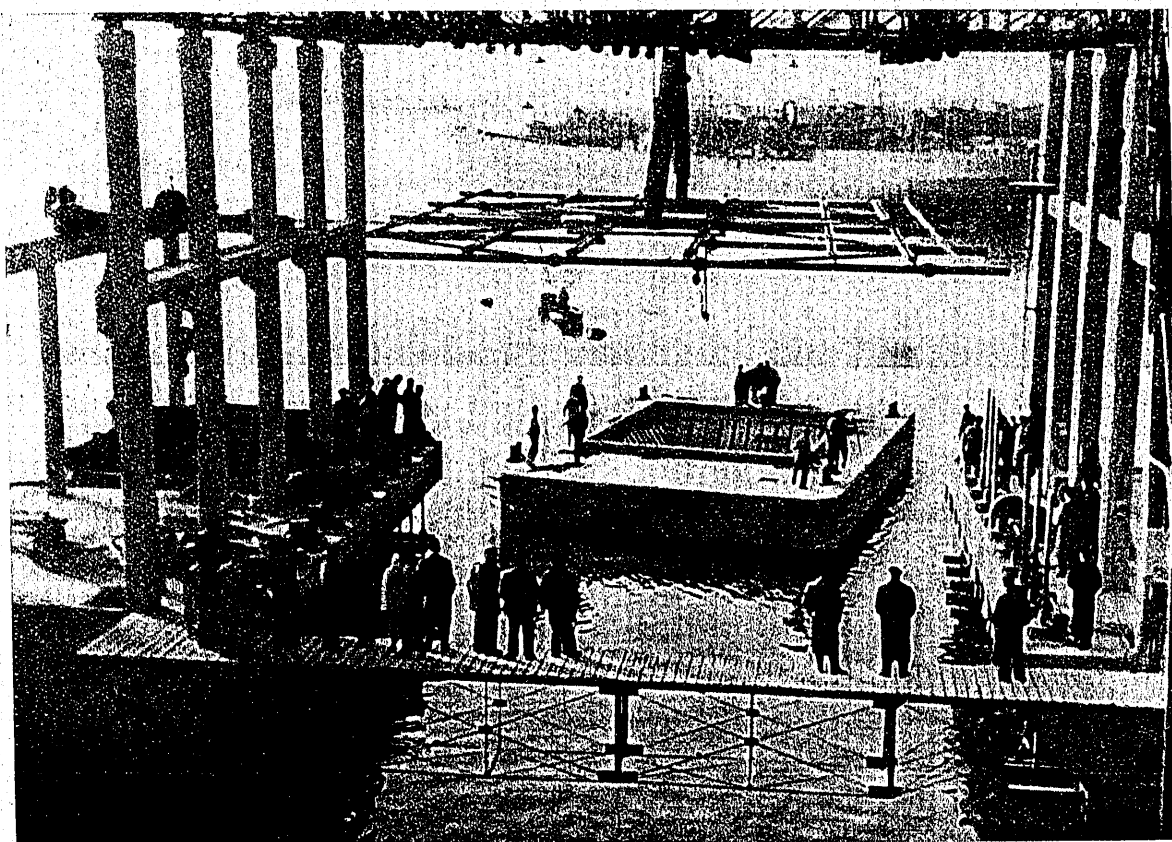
bis. — Botadura del gánguil de hormigón para la escollera de cimentación.
